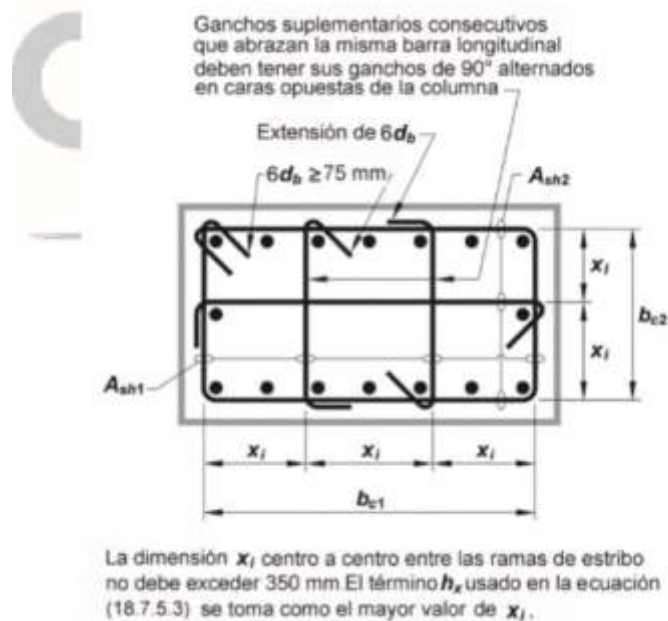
EJEMPLO DE REFUERZO TRANSVERSAL EN COLUMNAS
